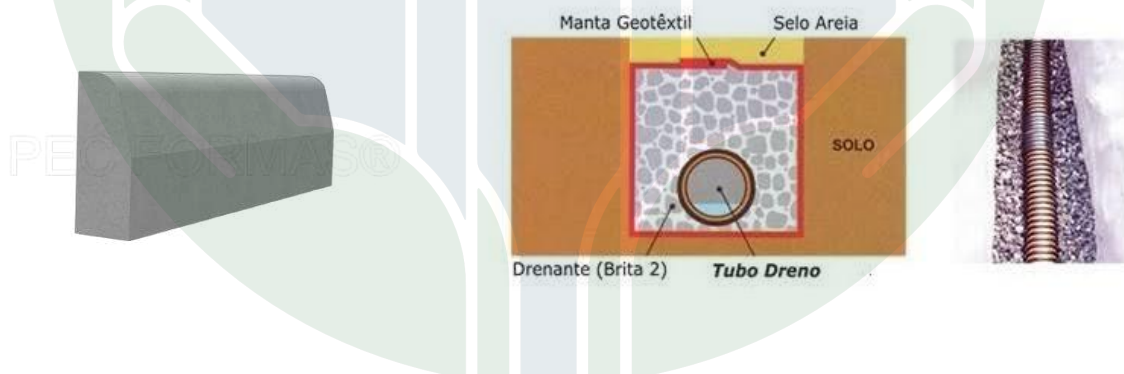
meio fio pré-moldado e tubulação flexível perfurada PEAD;
